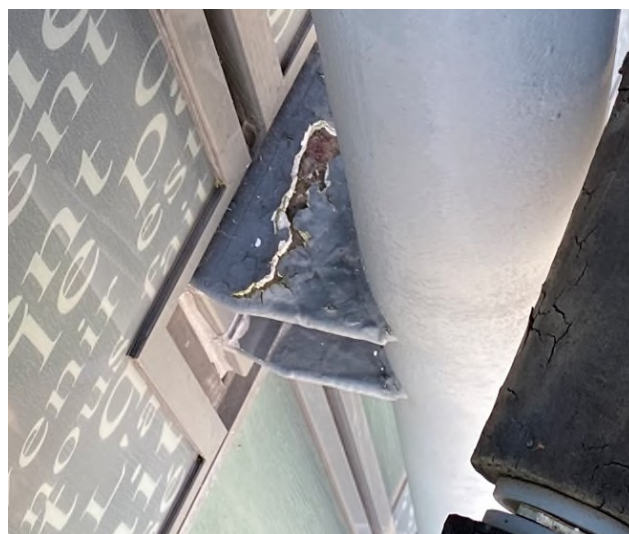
R+15 platine de jonction poteau / poutre présentant un revêtement très dégradé
